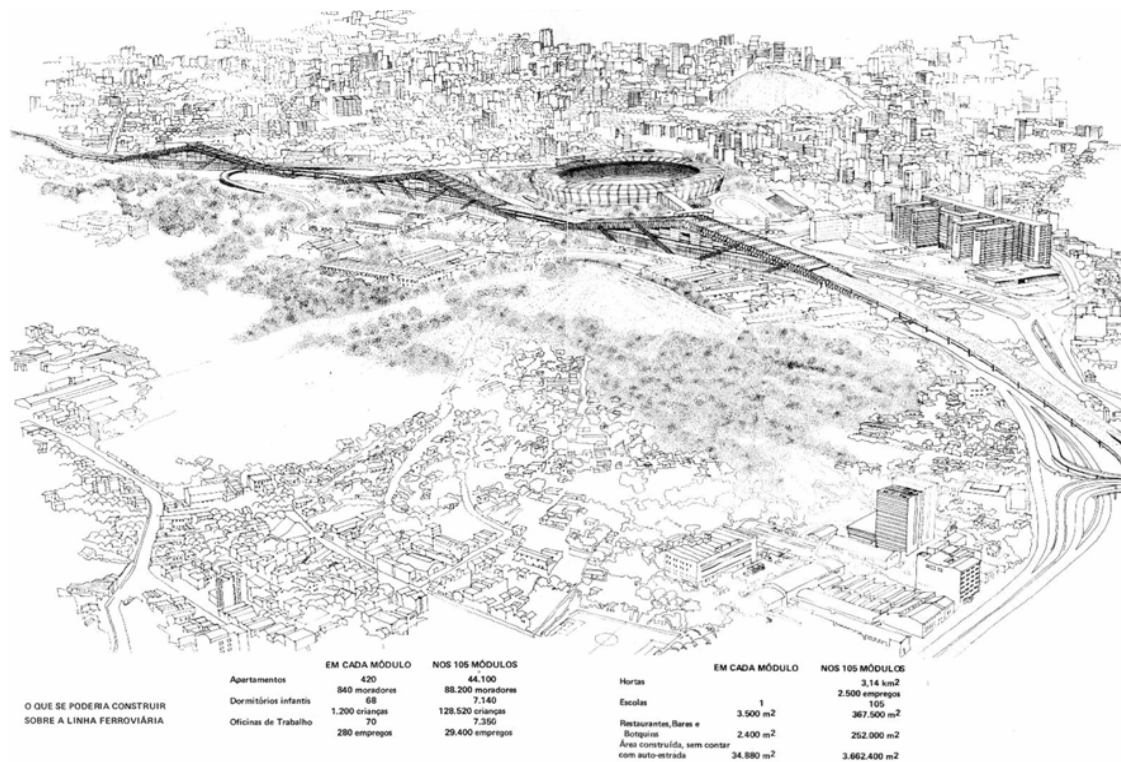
Plano de ocupação da faixa urbana de linha férrea no Rio de Janeiro – Arquiteto Sérgio Bernardes (Revista Módulo, 1983)
